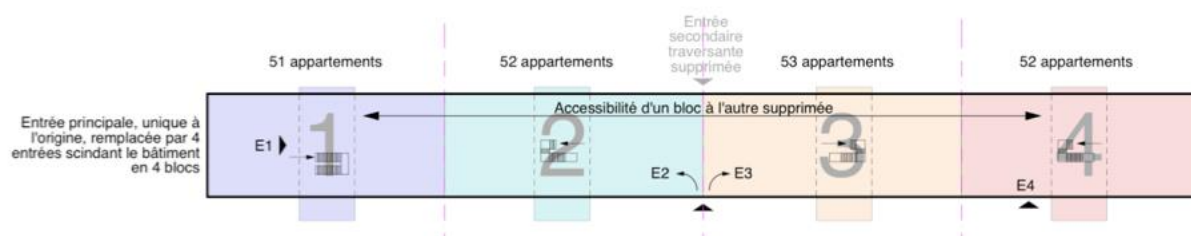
Schéma des circulations au rez-de-chaussée (AW Architectes, 2013)
